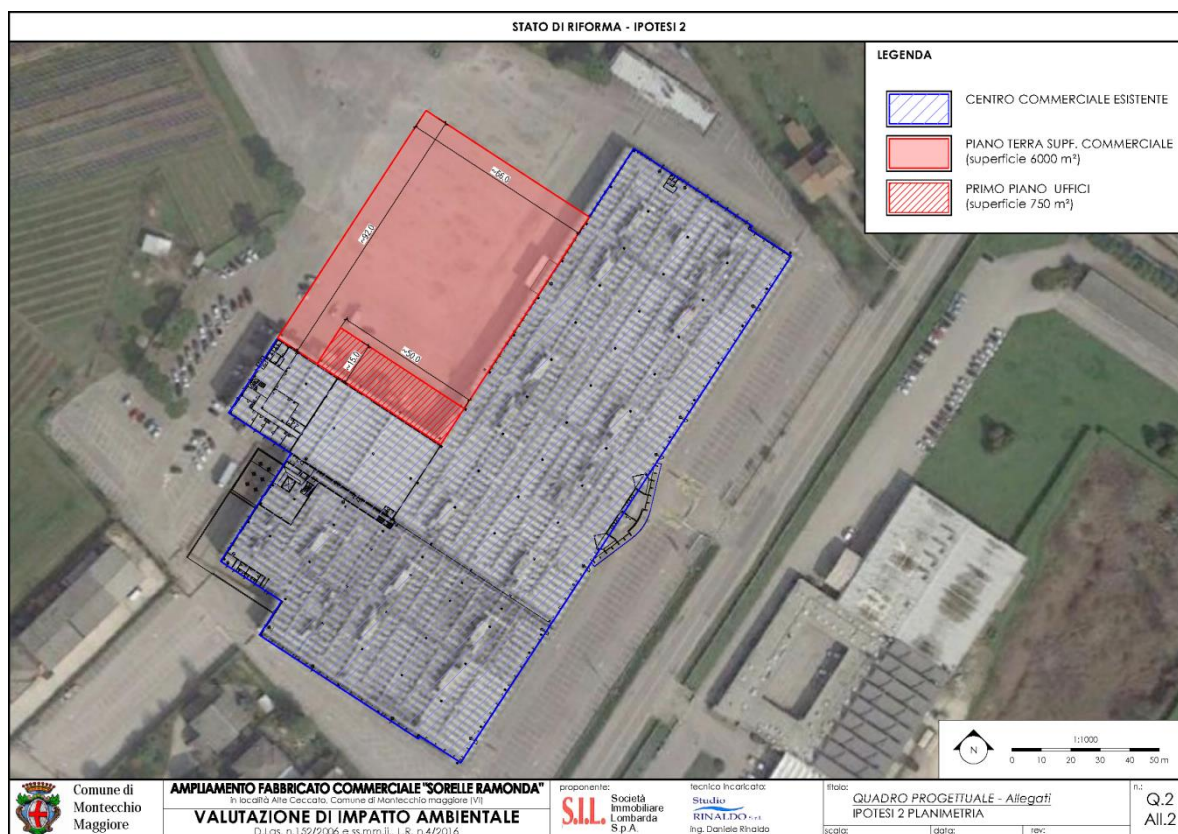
Ampliamento edificio esistente, Ipotesi 2 Planimetria
